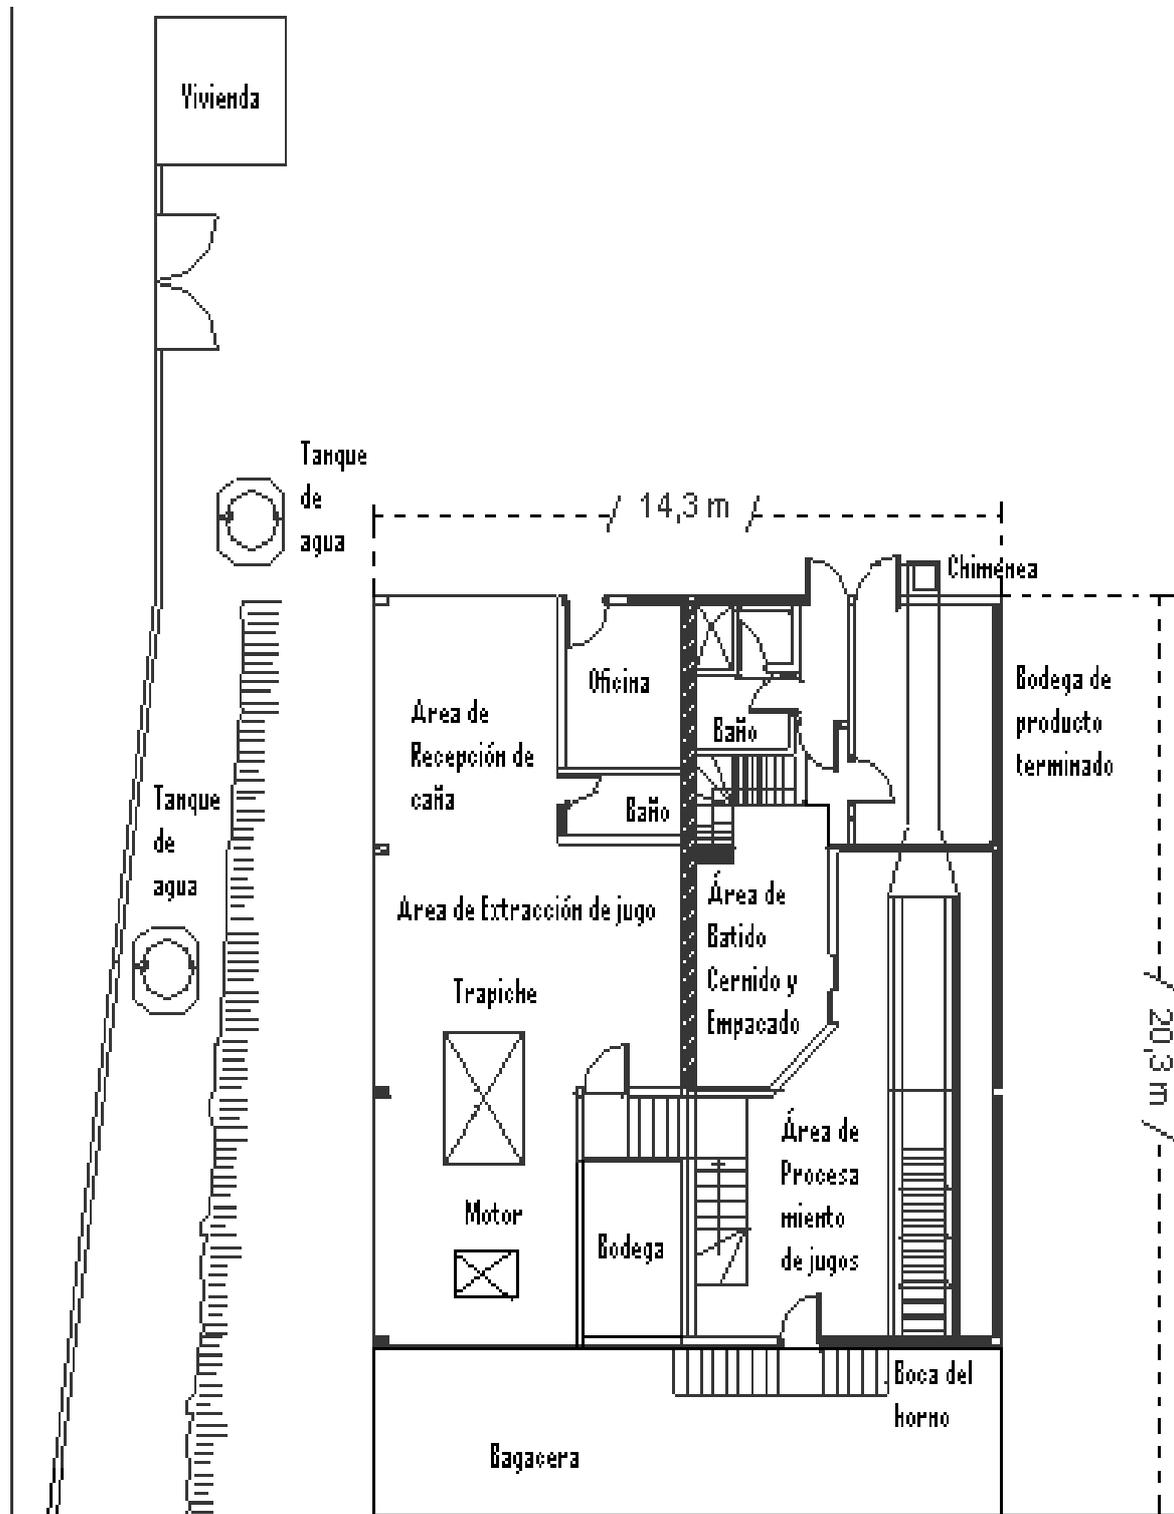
Esquema de la infraestructura de la planta panelera Ingapi.
